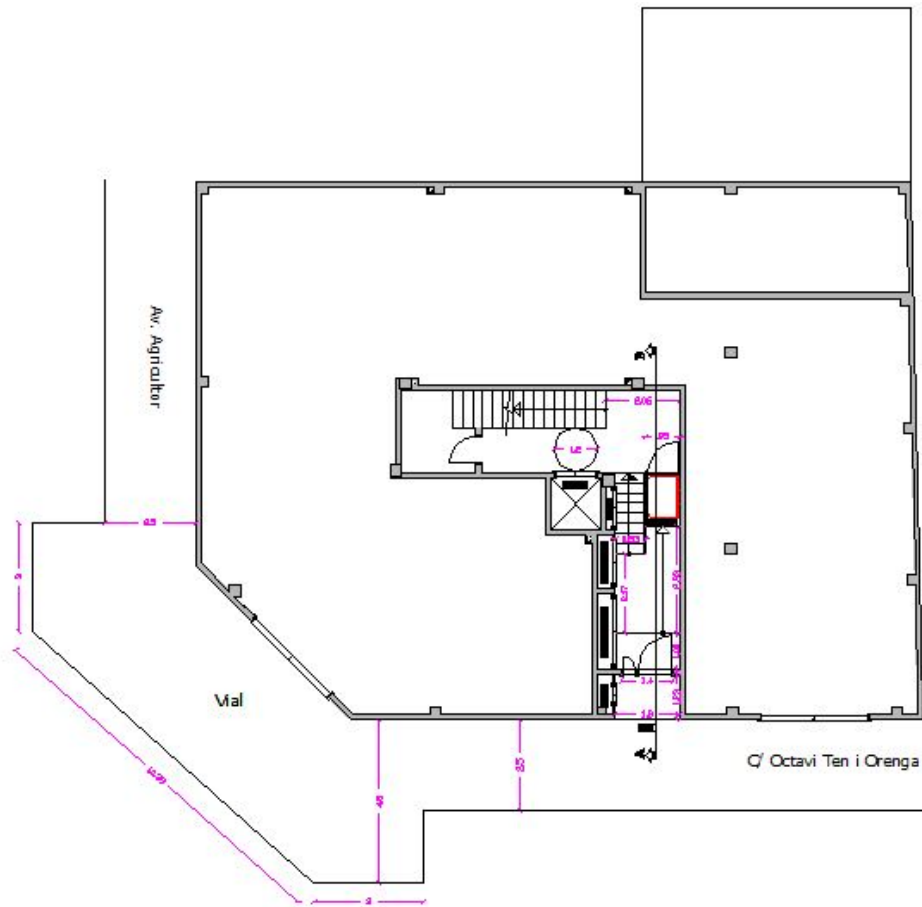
Accesibilidad, planta baja modificada [Anexo II. Planos]
